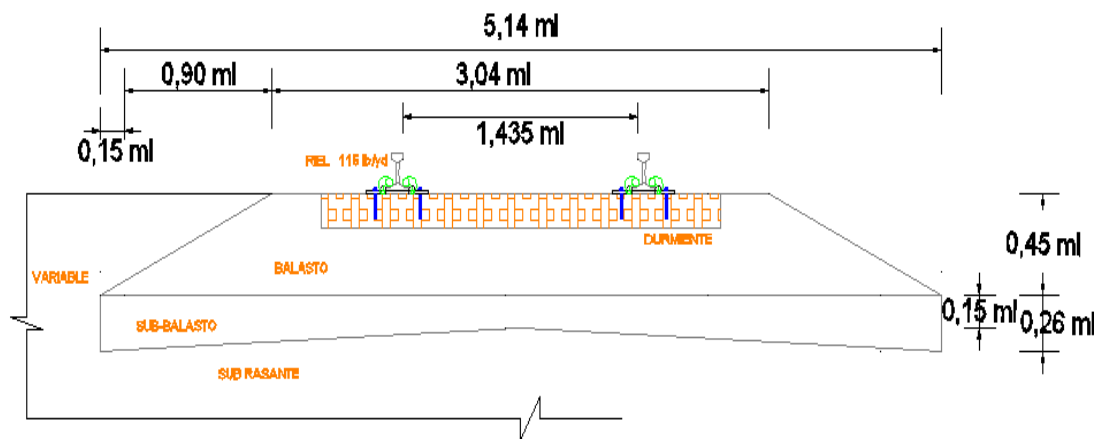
Corte de la Sección de la Vía Férrea, fuente propia
